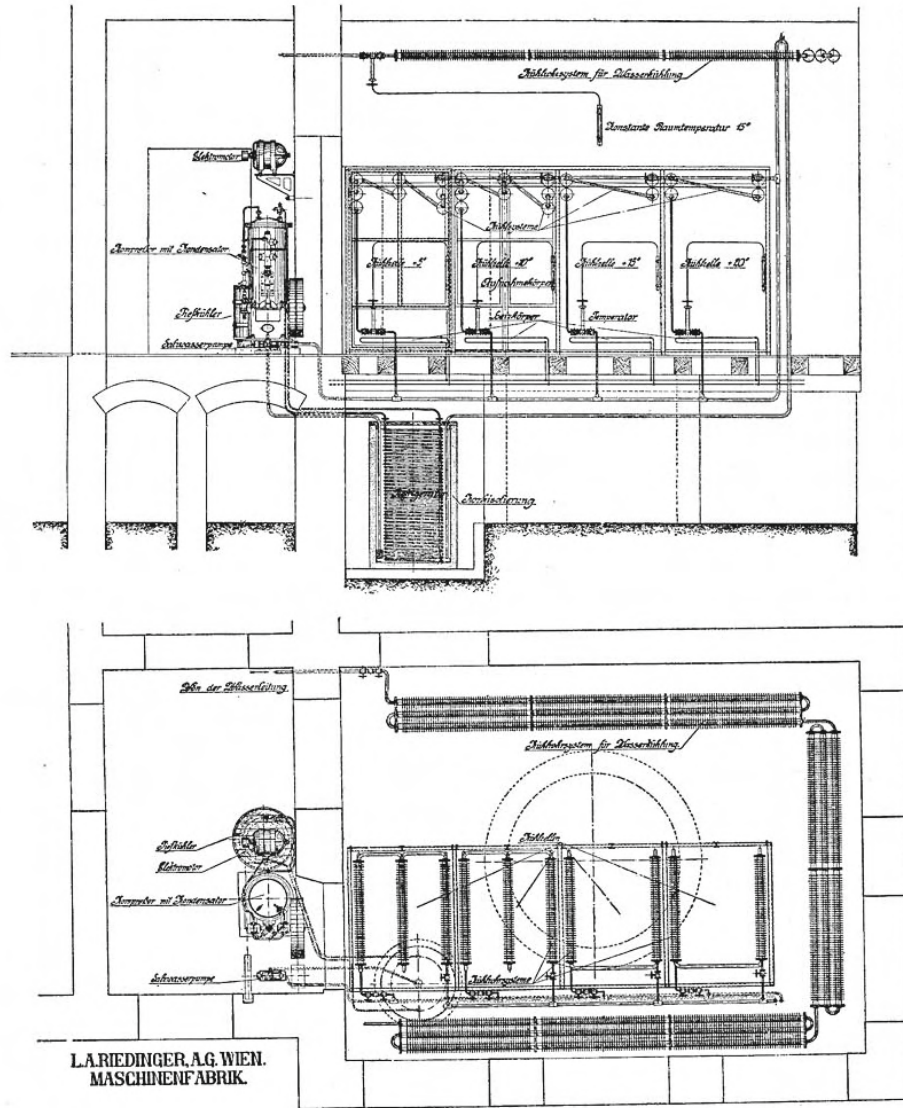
Grundriss des Kellergeschosses des Vivariums, 1944
